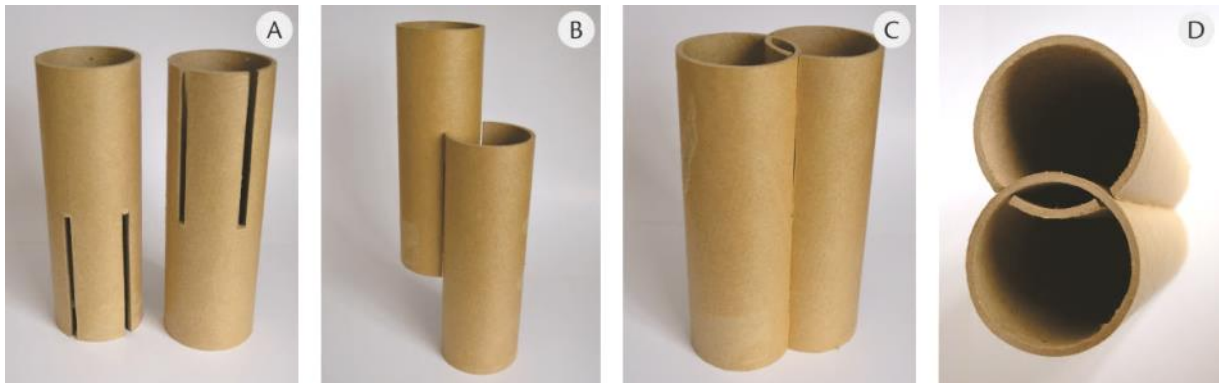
União encaixada em colméia. (A) Peças cortadas; (B) Encaixe sendo realizado; (C) União finalizada; (D) Detalhe da vista superior da união.
